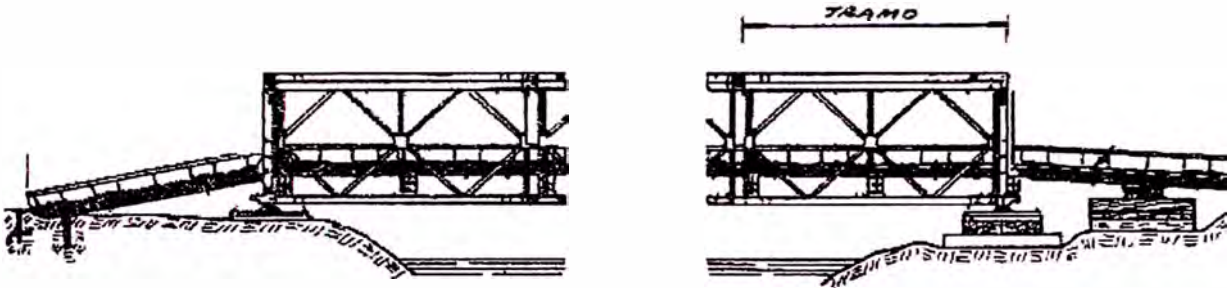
Vista Frontal Puente Bailey D-S
